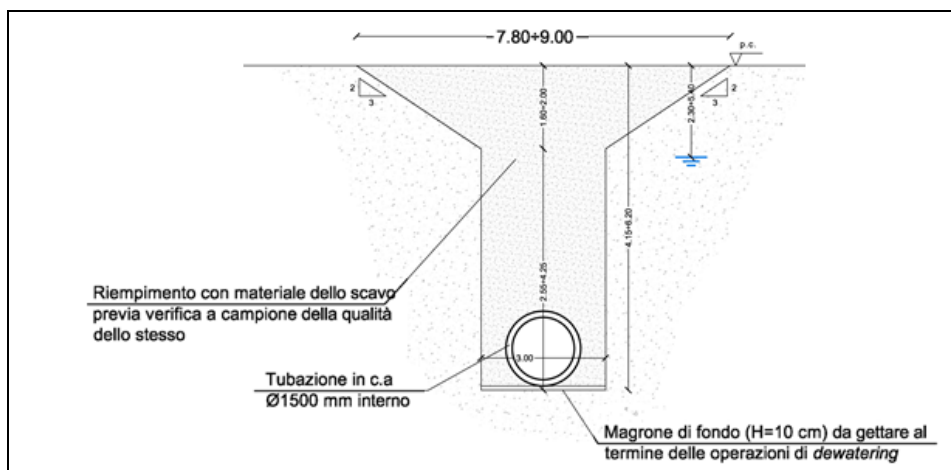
q – Sezione del dreno in un tratto non coincidente con il nuovo T. Marmazza
